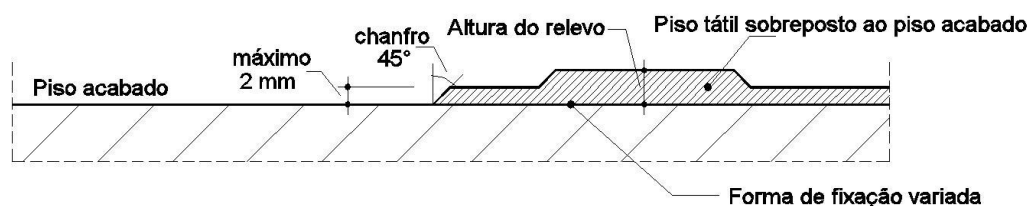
Detalhe do piso tátil sobreposto ao piso acabado
